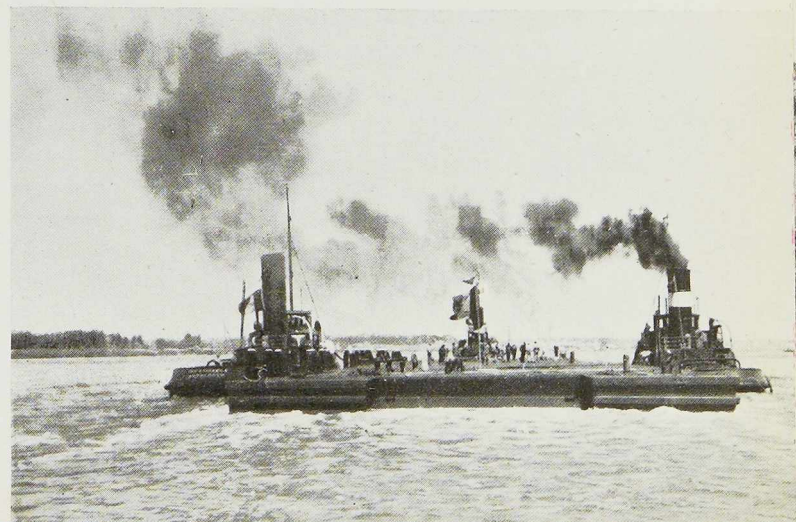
(ci-contre). Lançage d'un des caissons sur le chantier de Tamise.
